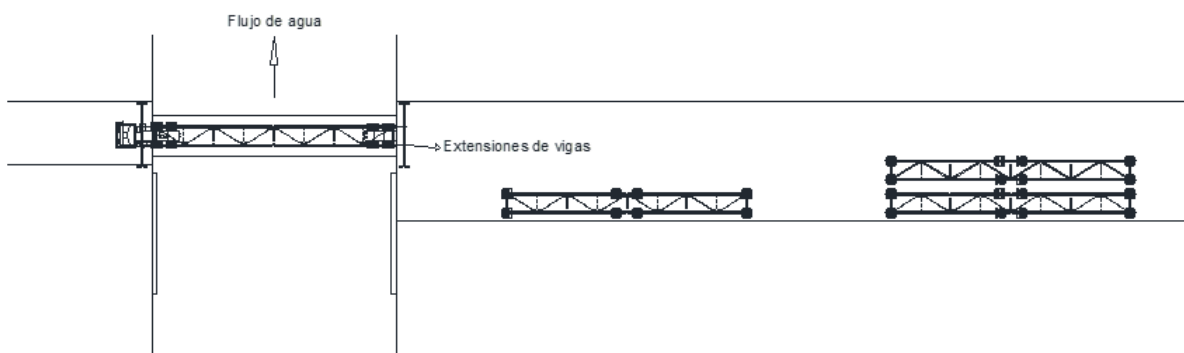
Elevación de las vigas para que el dolly quede liberado
